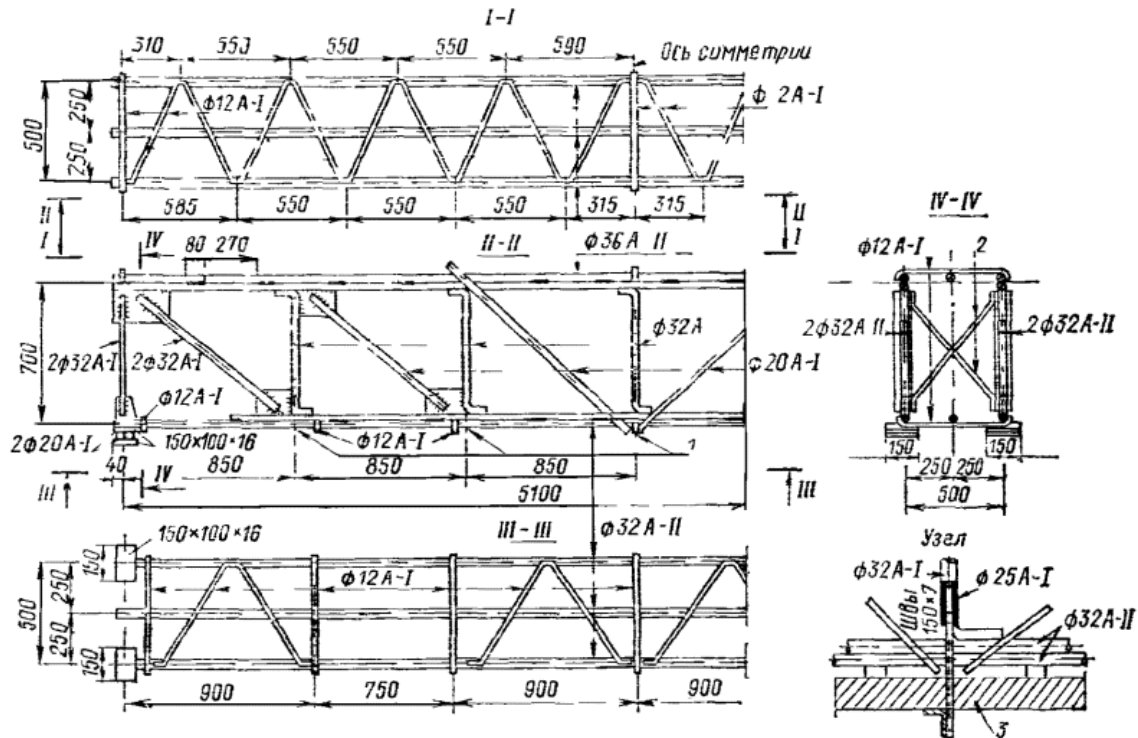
Несущая армоферма с подвешенной к нижнему поясу опалубкой
